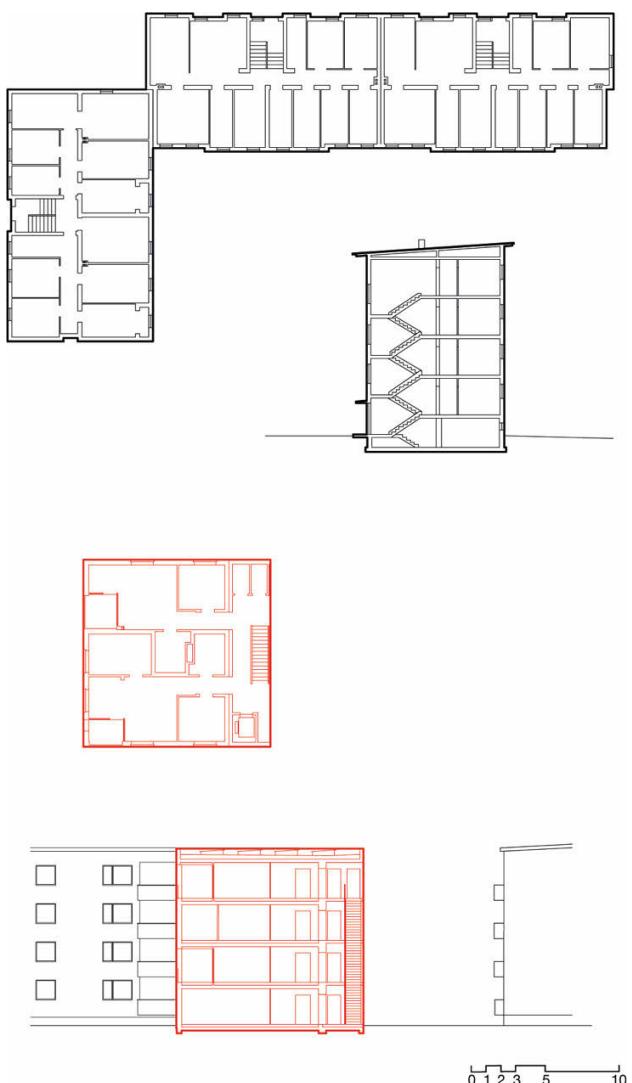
Grundrisse & Schnitte Bestand – Nachverdichtung, Bremer Punkt
